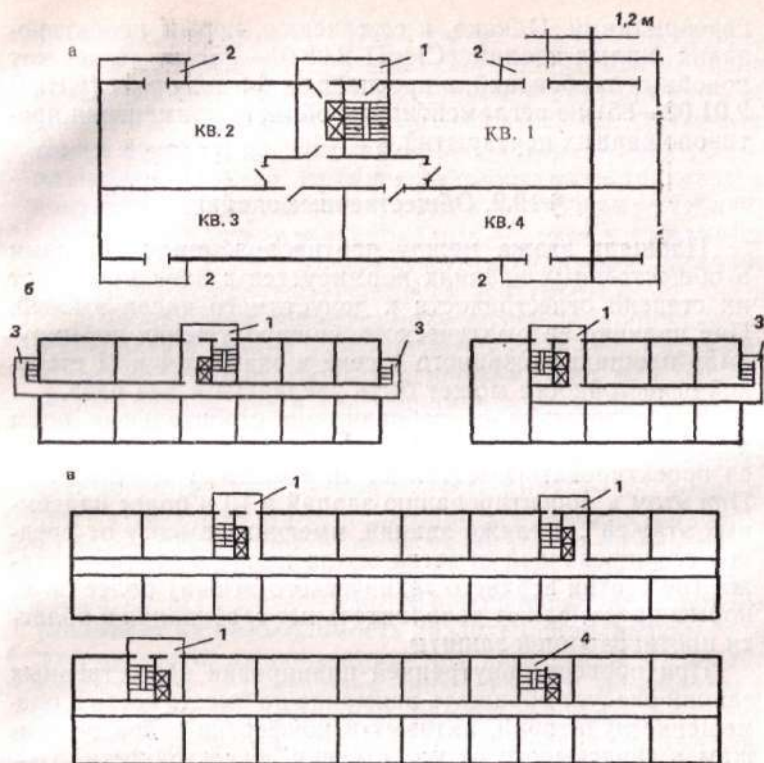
Схемы размещения незадымляемых лестничных клеток в жилых зданиях
